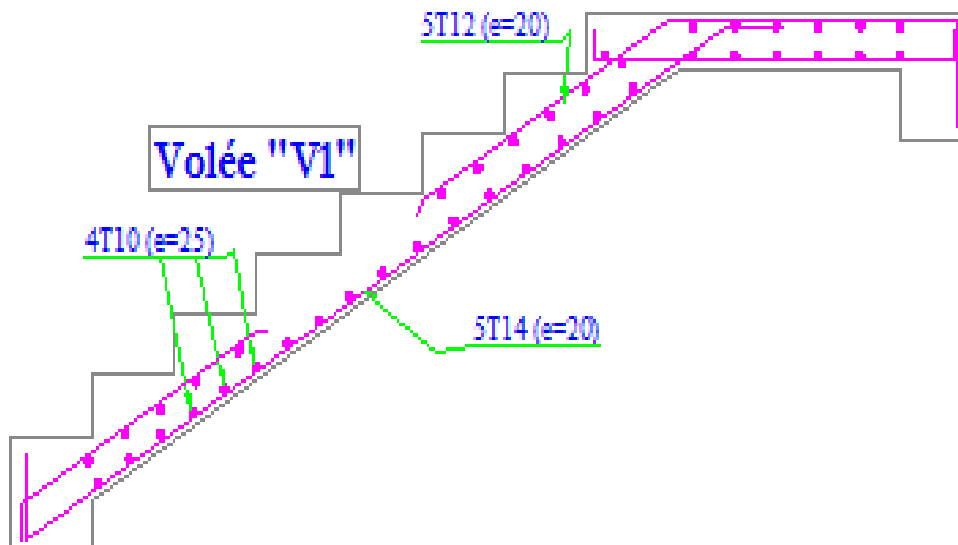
Ferrailage de la volée 1 d'escalier de RDC (type 1).
